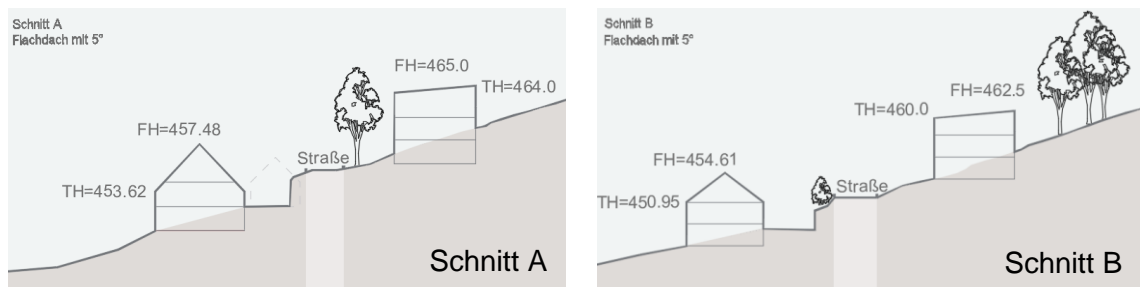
Schematische Darstellung einer möglichen Bebauung mit einem flach geneigten Dach (eigene Darstellung)
